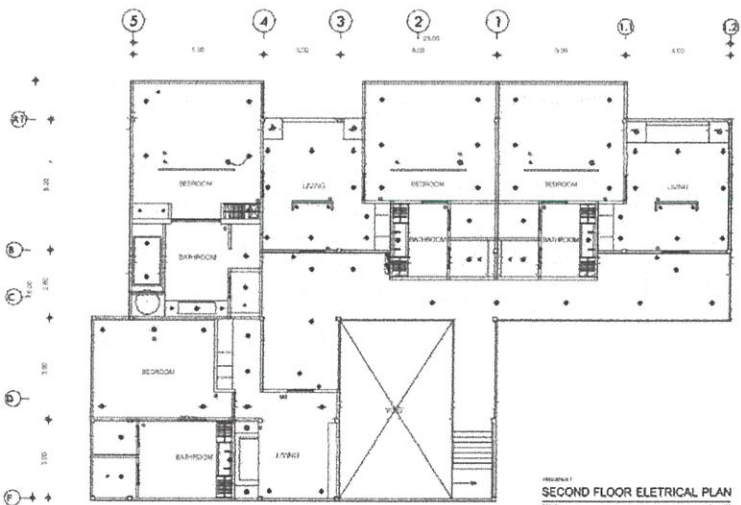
MAIN BUILDING ELECTRICAL PLAN
